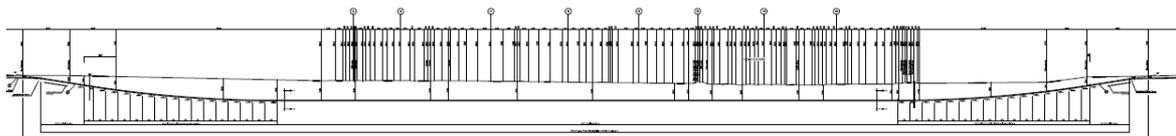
Attraversamento fiume Fortore - Sezione schematica di progetto
